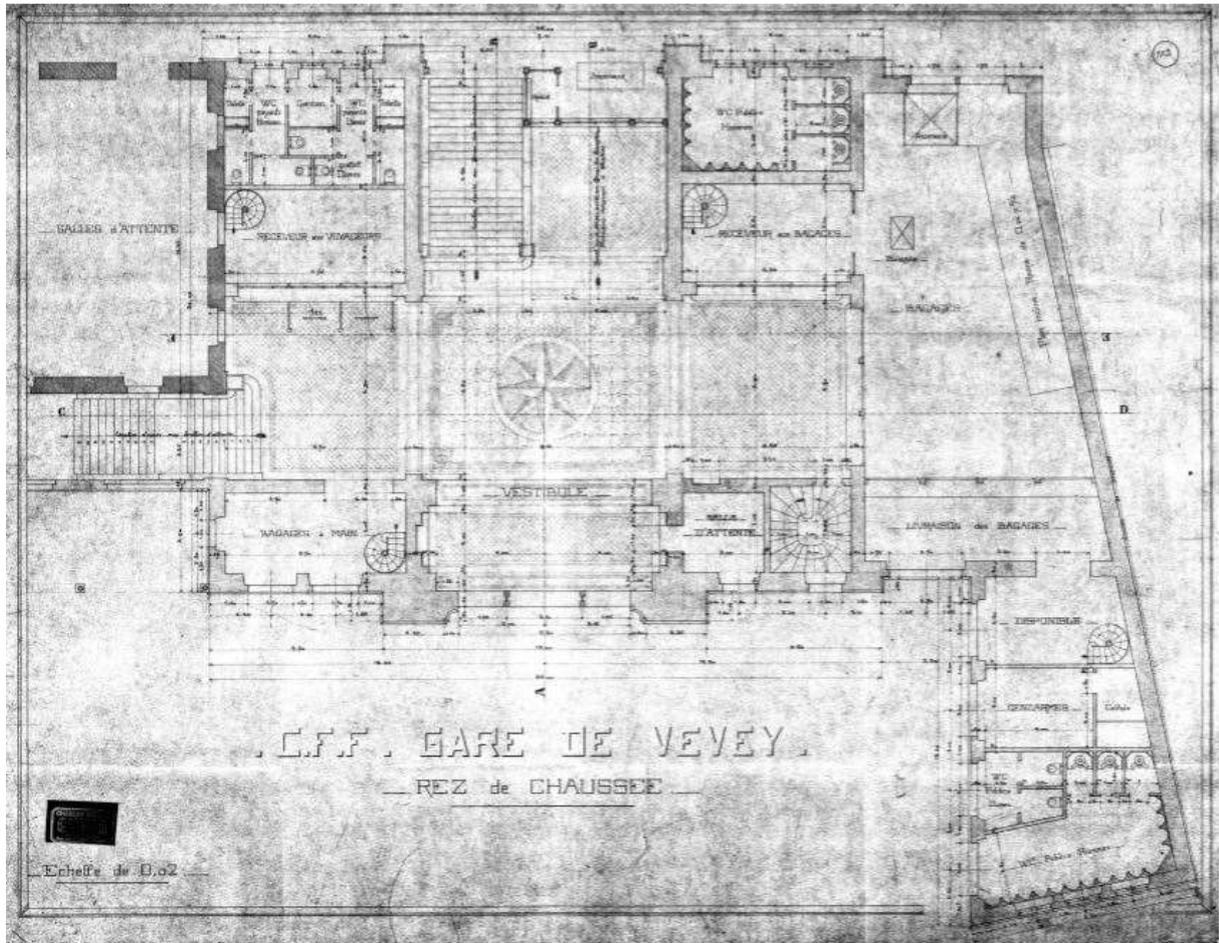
Nouvelle gare de Vevey, plan du rez-de-chaussée, Charles Coigny architecte, 13.8.1908 (CFF Lausanne Immobilier, SBB-IM-WEST 18000/101).
